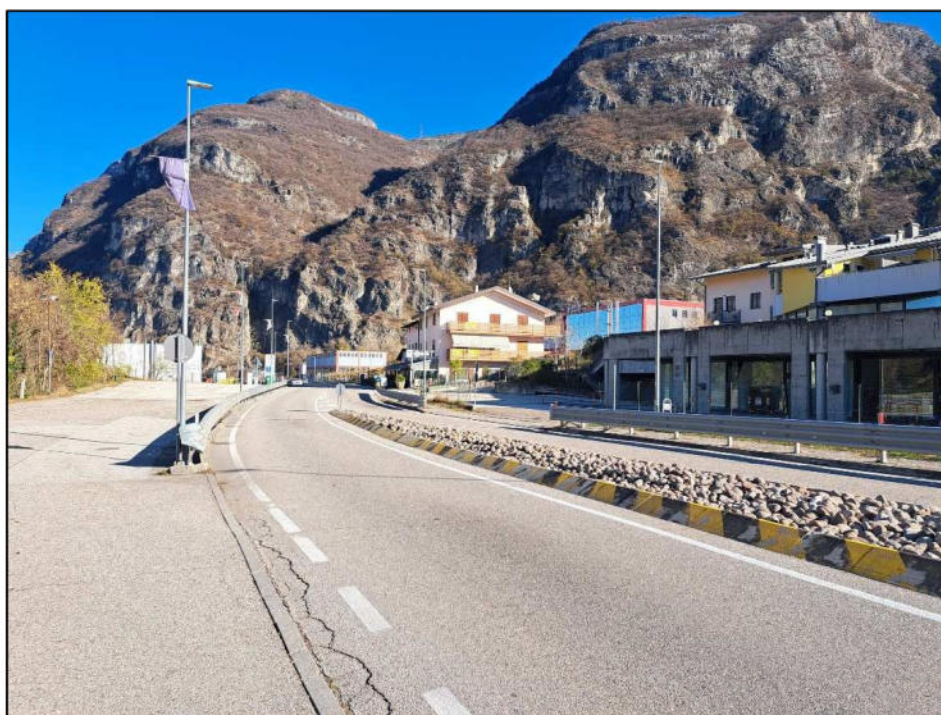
viabilità tangente la p.ed. 918, S.S.12 del Brennero – presa da sud.
